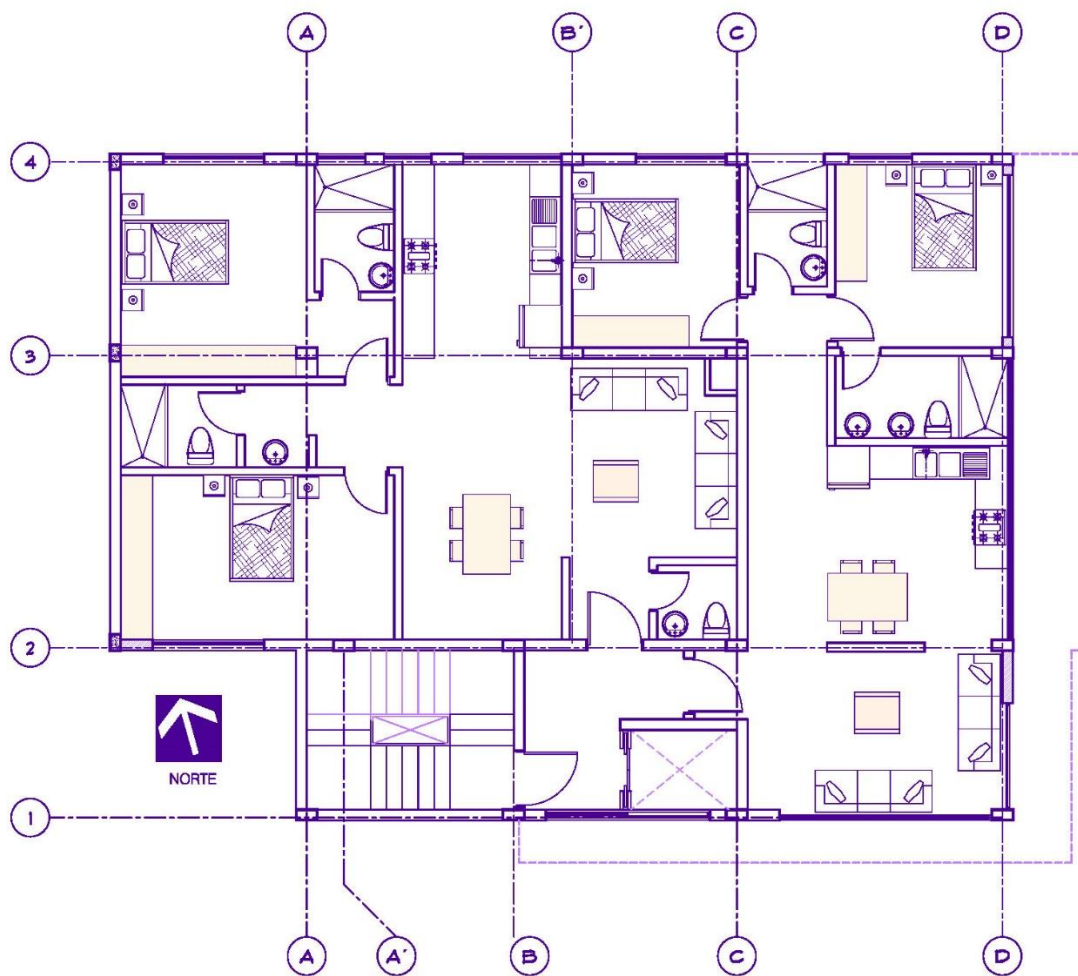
Planta Baja -Elaborado por: Alejandro Albarracín.
